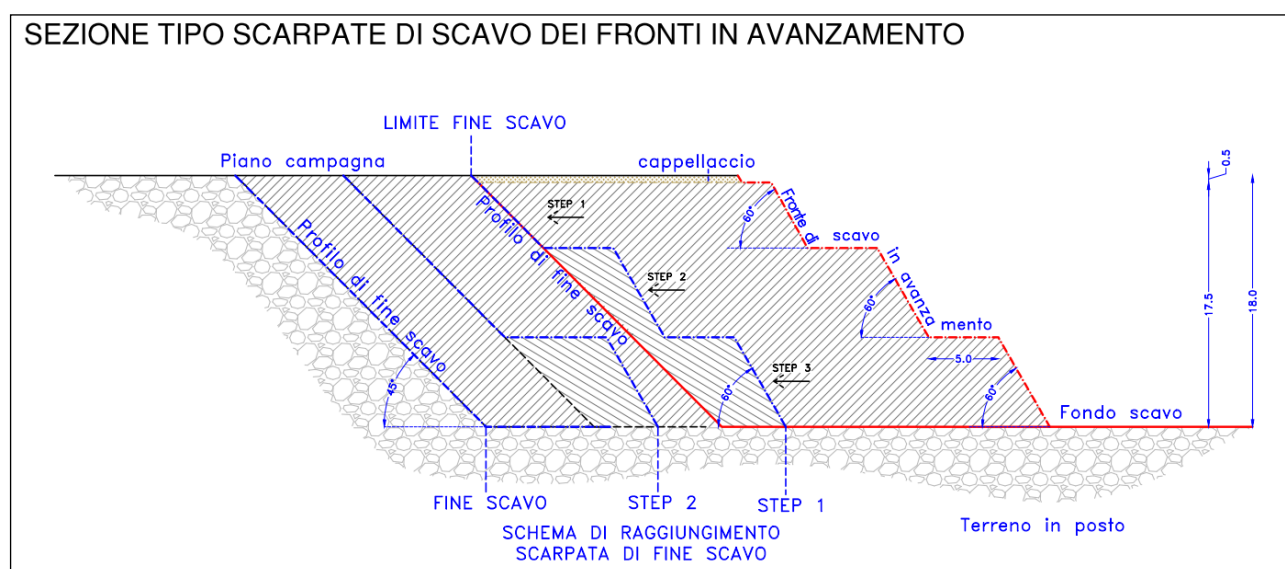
Sezione tipo di scavo dei fronti in avanzamento e di fine scavo
